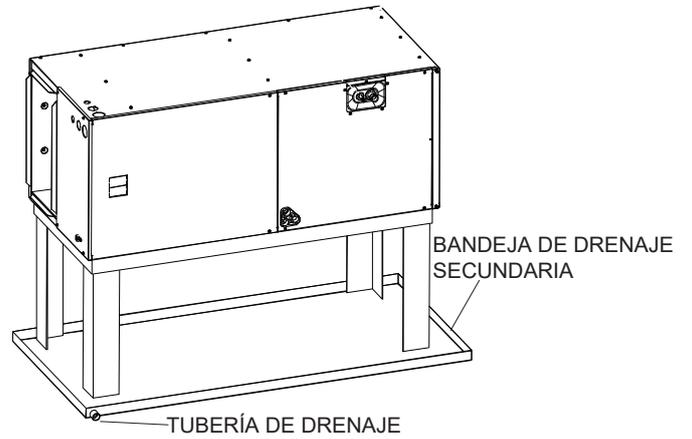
INSTALADA HORIZONTALMENTE IZQUIERDA
